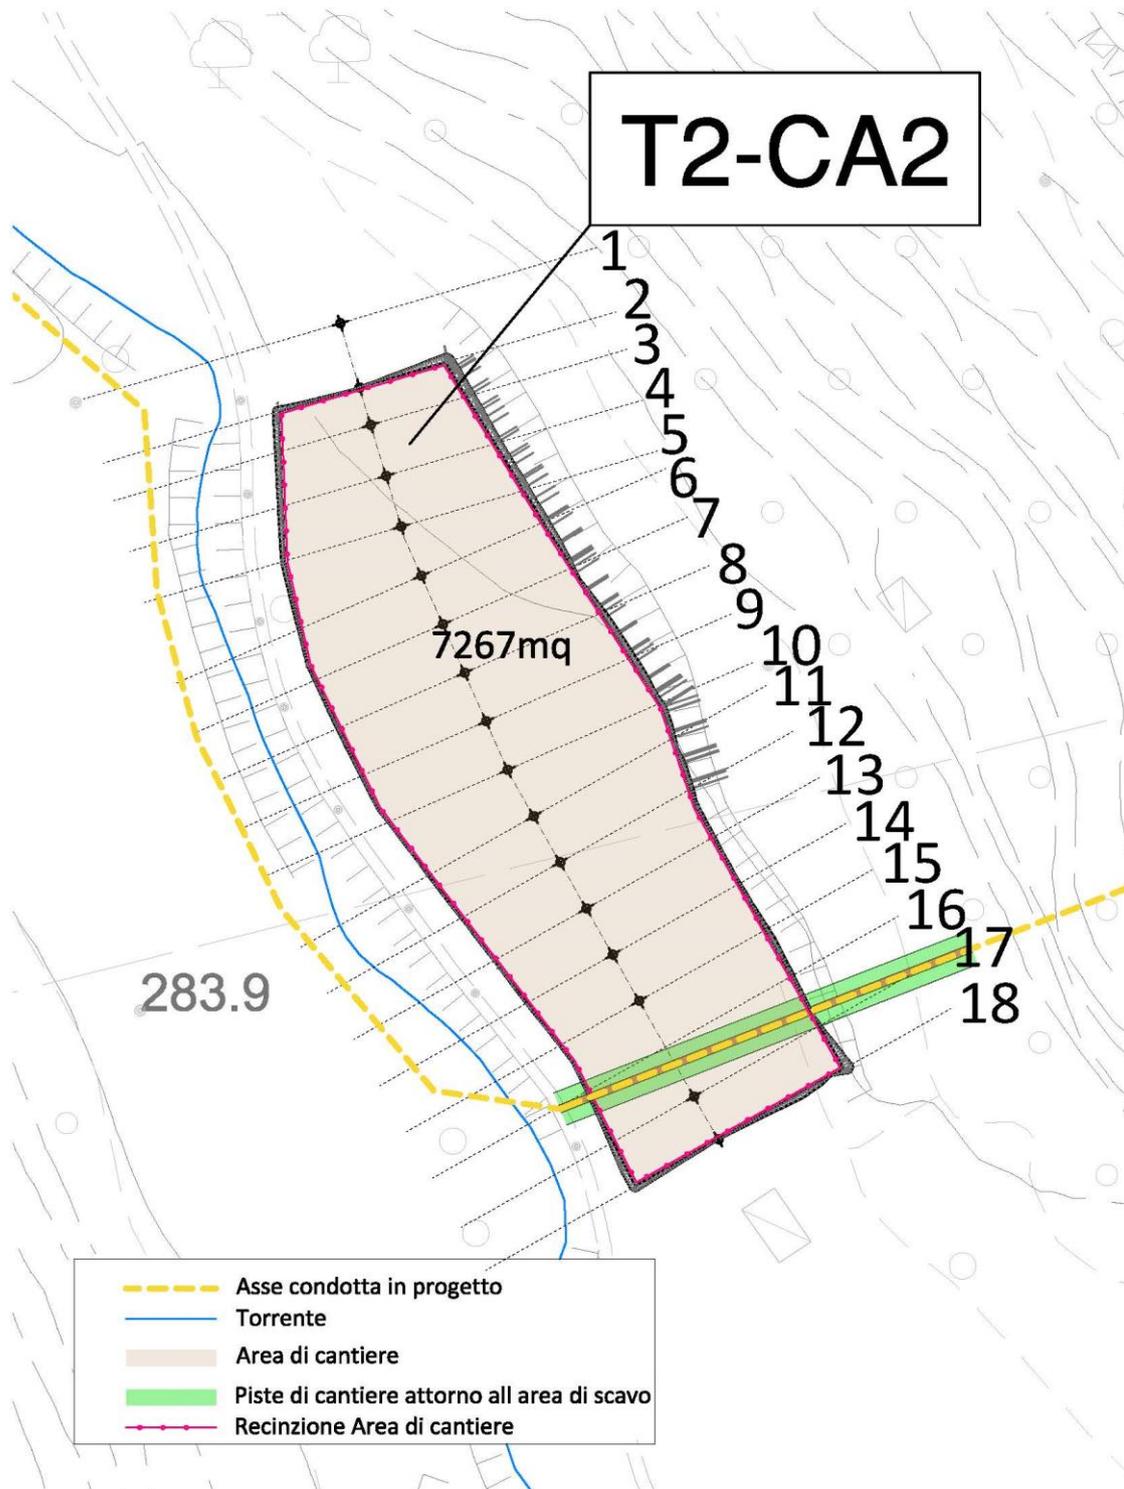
Inquadramento Planimetrico area cantiere T2-CA2.
